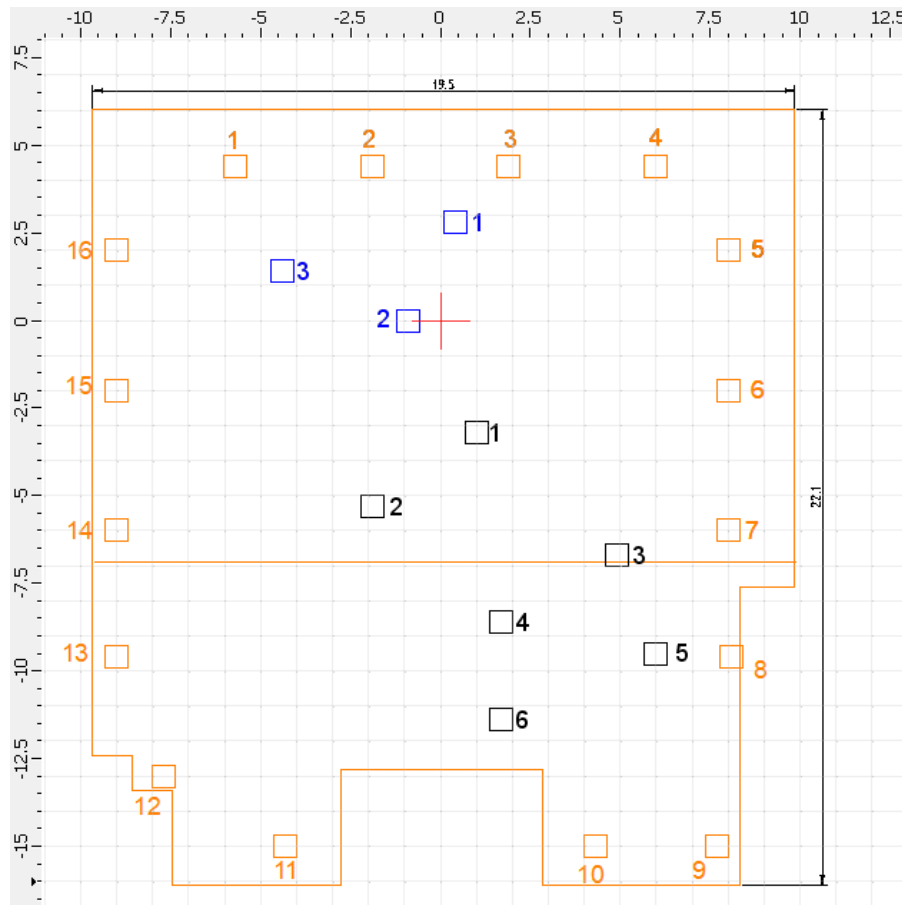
Grundriss TV-Studio mit eingezeichneten Messpositionen
